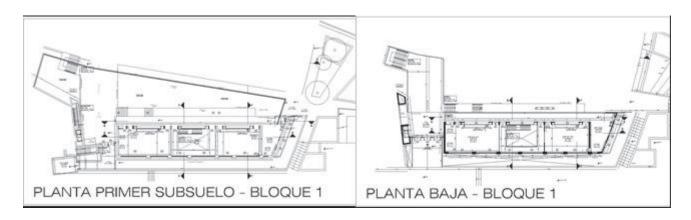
Planta 1er Subsuelo y Planta Baja (AUTOCAD)
